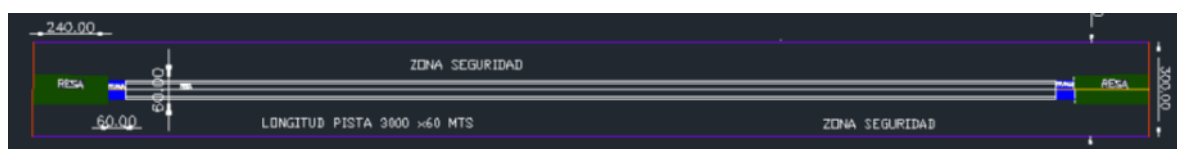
Detalle de las dimensiones de las zonas de franja y resa.
